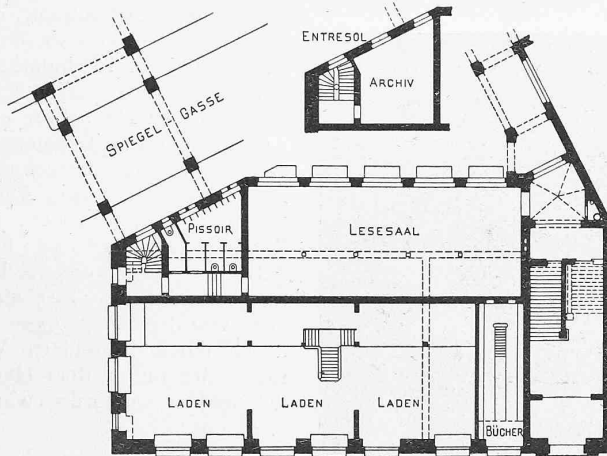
bis 5. Grundrisse vom Keller- und Erdgeschoss sowie vom ersten und zweiten Stock.
